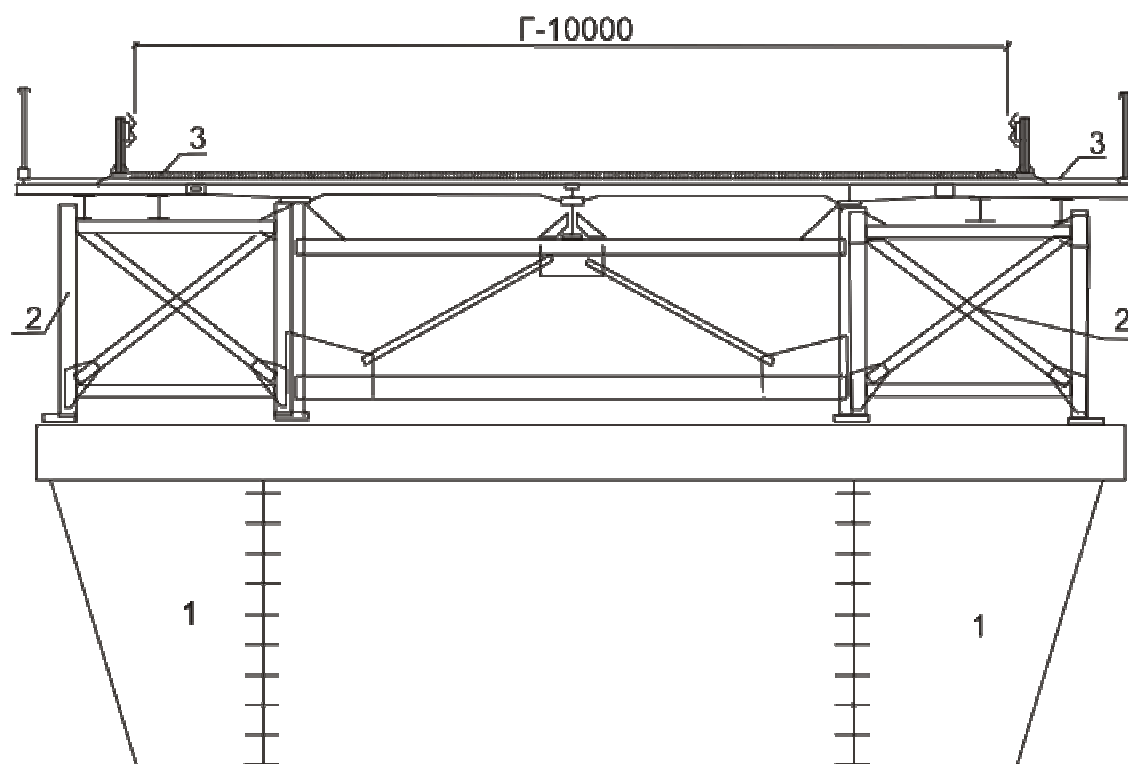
Уширение металлического моста постановкой дополнительных ферм или балок: 1 – уширяемая часть опоры; 2 – дополнительная ферма или балка; 3 – участок плиты уширения
